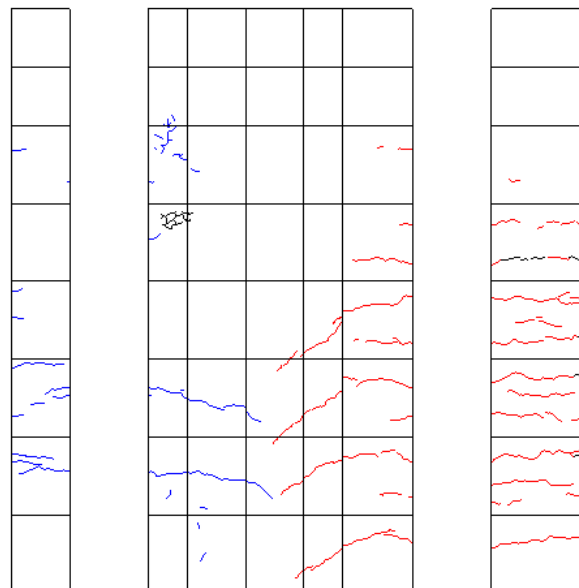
R=-1/400②ひび割れ図
